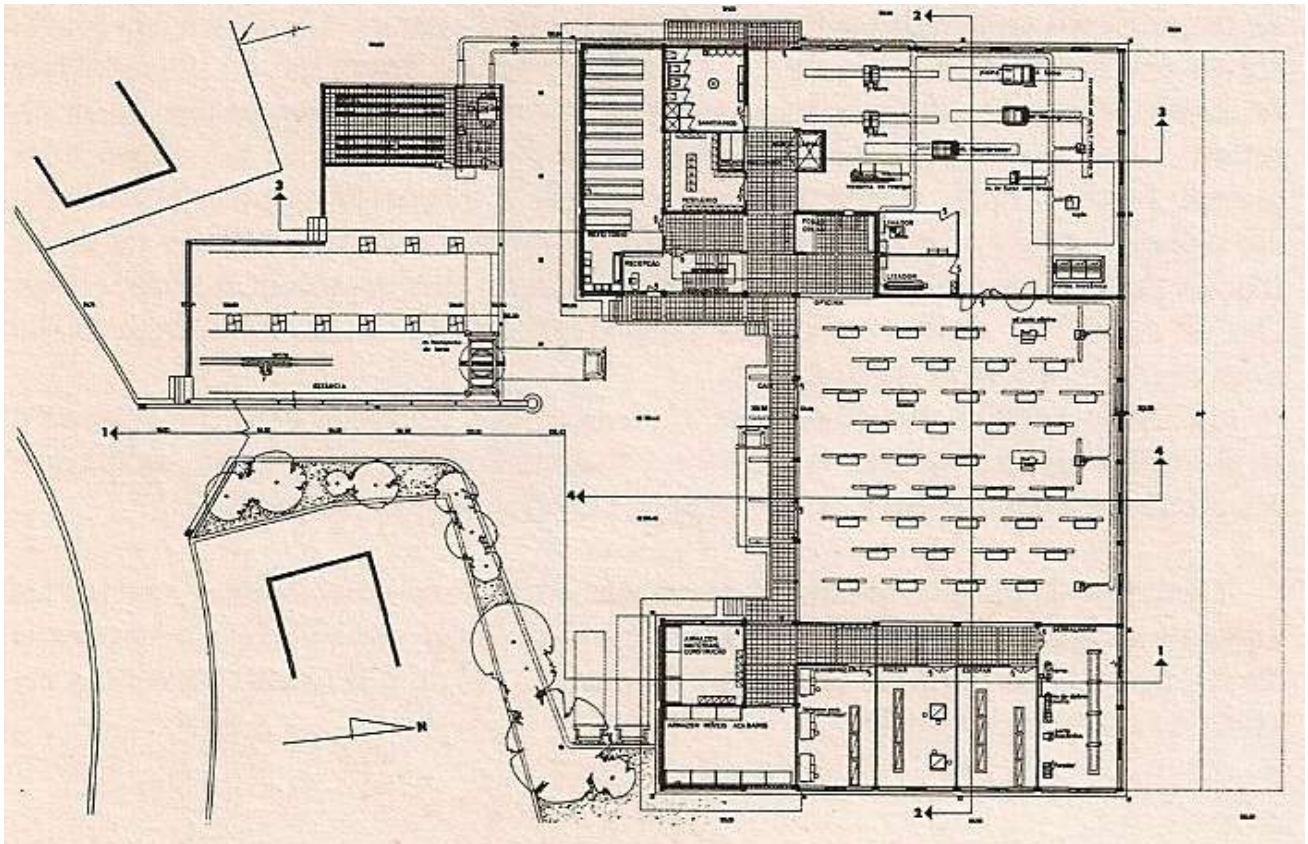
a) Fábrica de móveis em Fânzeres, Duílio da Silveira, corte e planta (revista rA, pág. 66).
